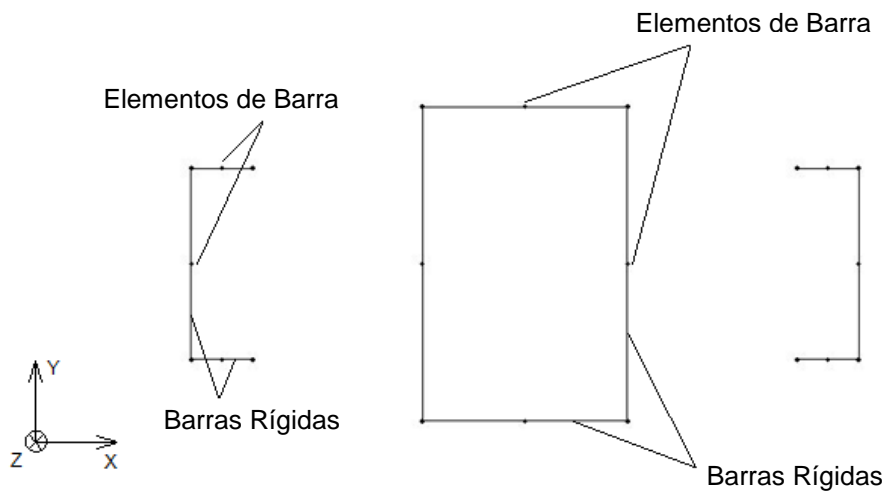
Vista em planta, até ao 37º piso, do núcleo central sem aberturas e dos laterais
